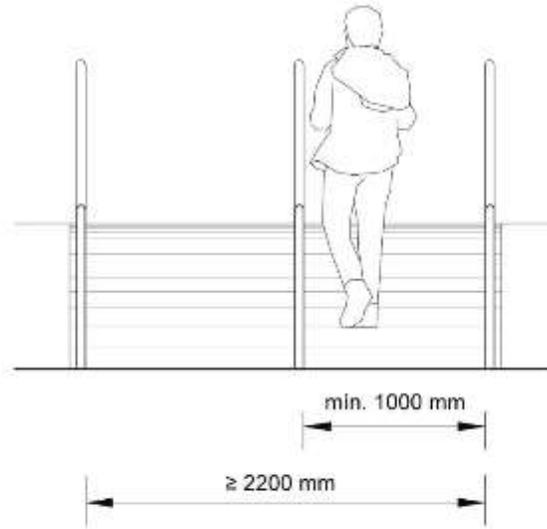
Pasamanos en rampas mayores de 2200 mm de ancho
